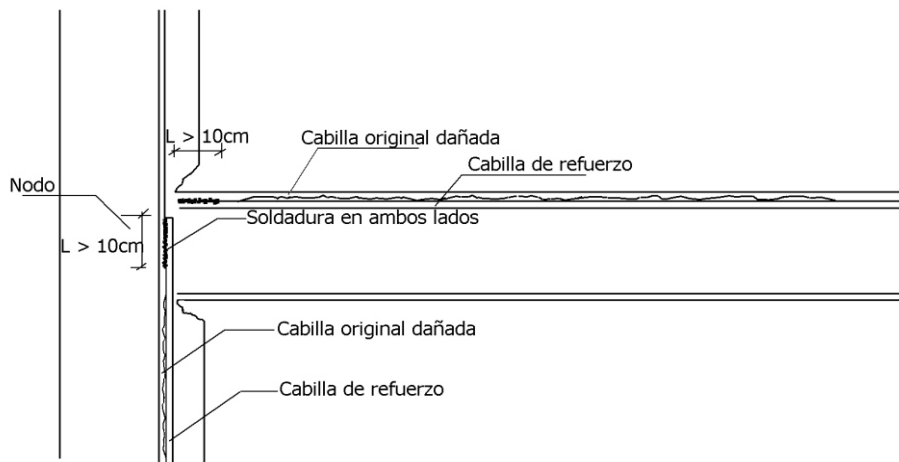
Detalle de colocación del nuevo acero de refuerzo en la reparación de juntas vigas-columnas.
